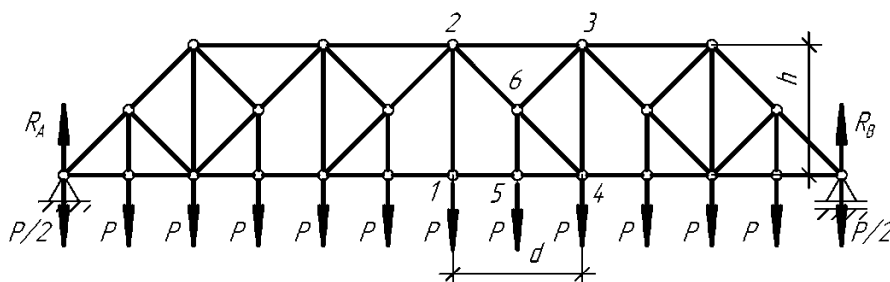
Расчетная схема фермы с двух ярусными шпренгелями
